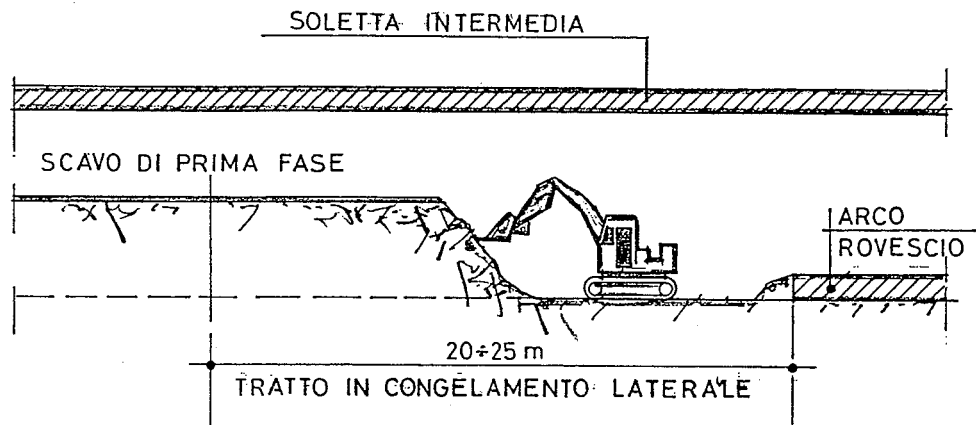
Avanzamento dello scavo frontale con protezione di due muri congelati lungo i piedritti.
